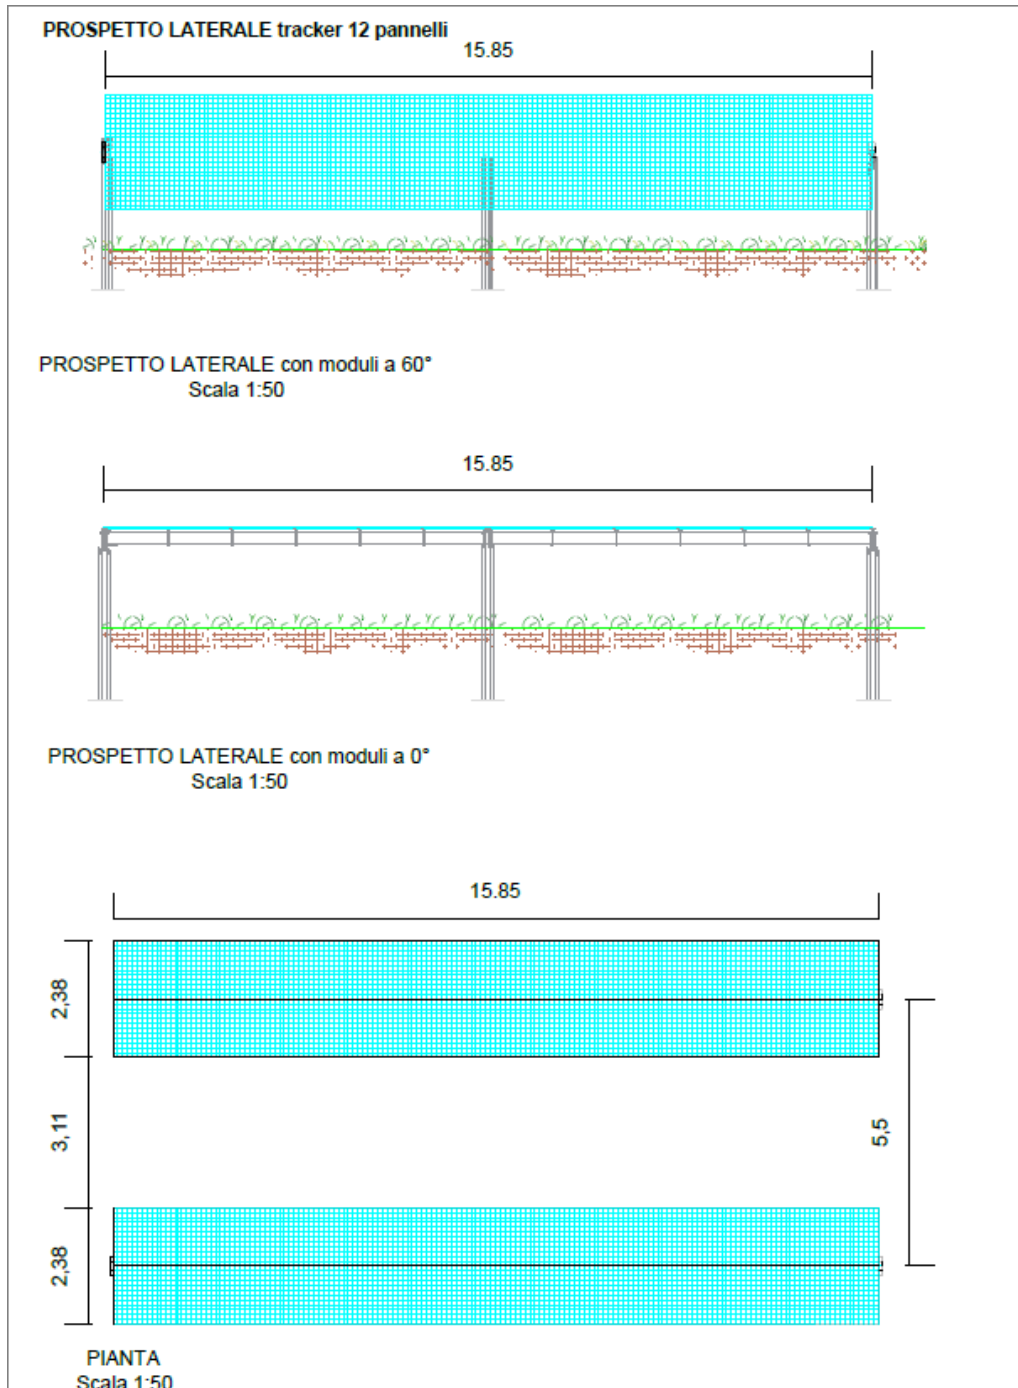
Vista in pianta e laterale delle strutture tipo tracker da 12 moduli previste a progetto
